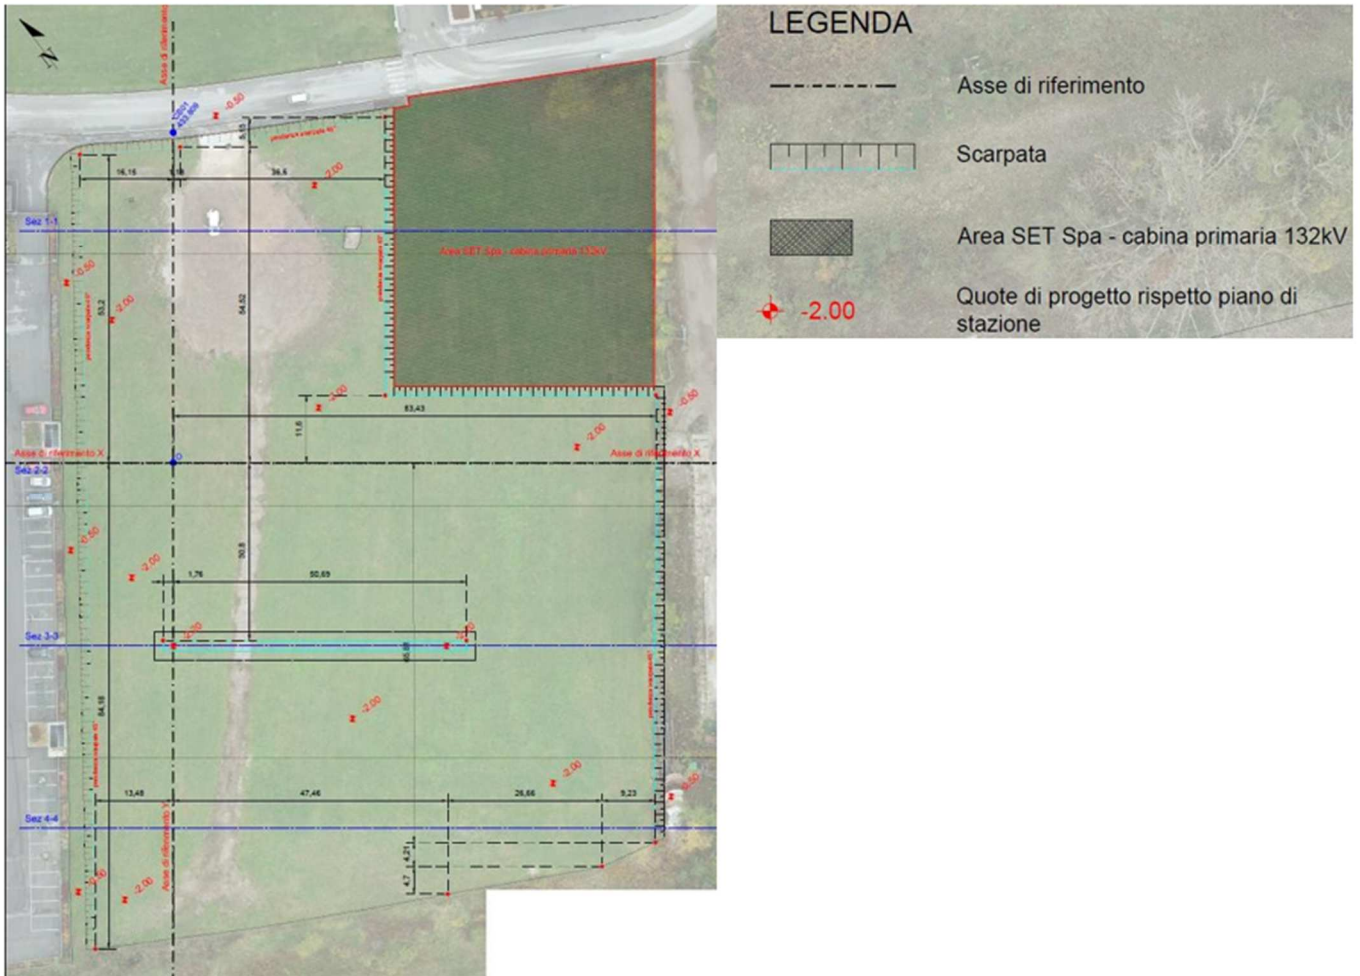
ESTRATTO DELLA TAVOLA "SCAVO E PREPARAZIONE SITO – PLANIMETRIA E SEZIONI" (COD. DC33452AC2359063)
